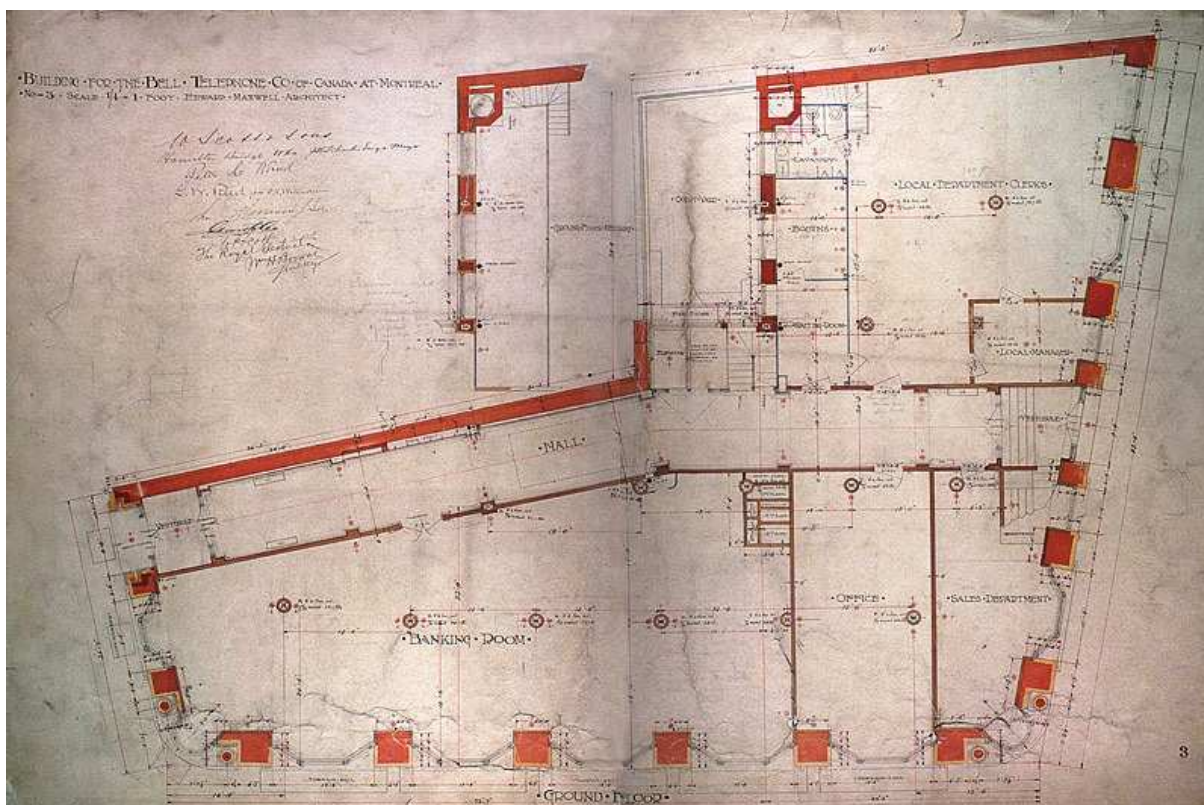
Montréal, Rue de Notre-Dame, plano original de la planta baja. Fuente: McGill University.
